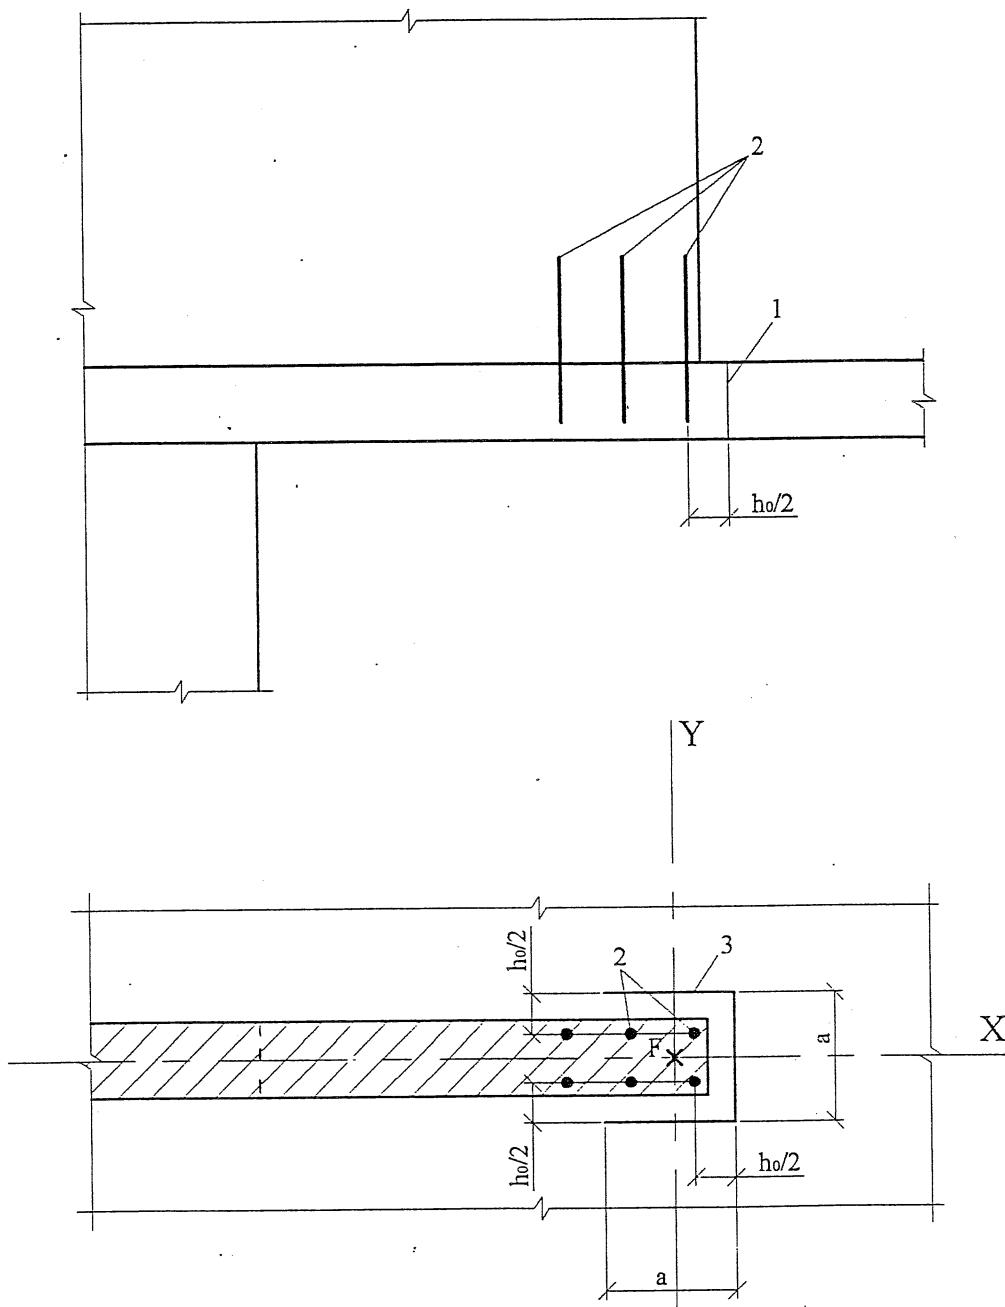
Схема для расчета железобетонной плиты при подвеске перекрытия к вышележащей стене
